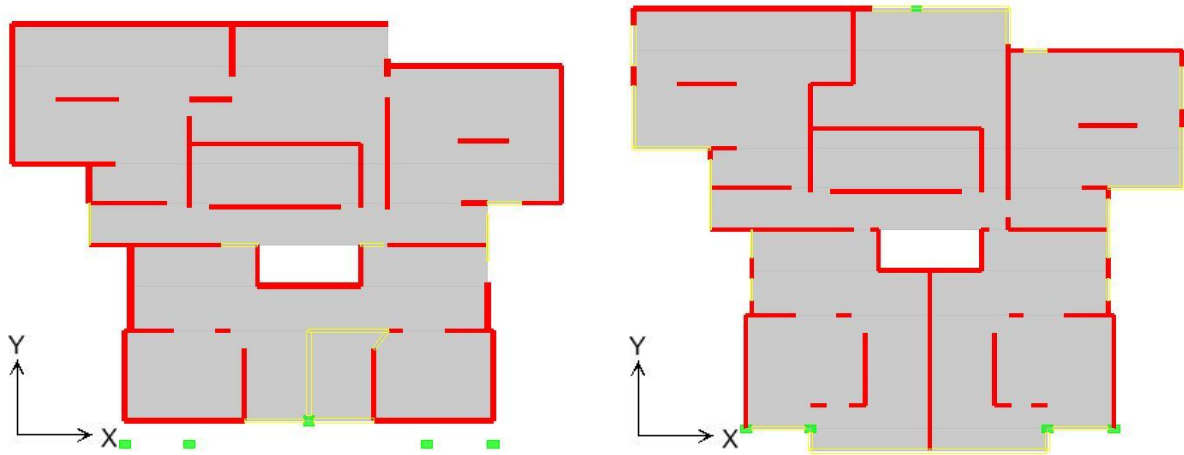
Planta primer piso (izquierda) y piso tipo (derecha) edificio H8
